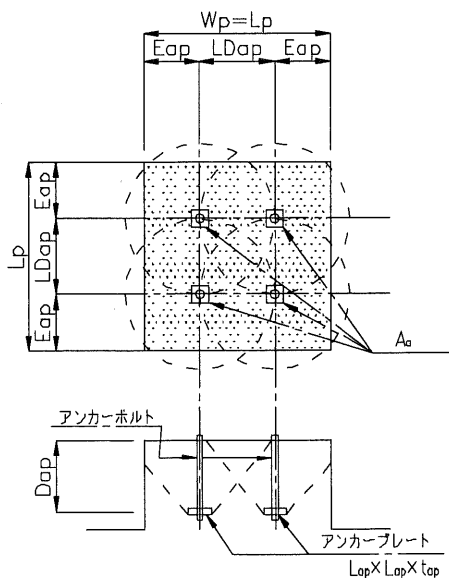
アンカーボルト有効投影面積説明図
